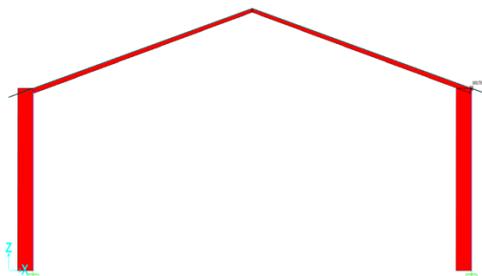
Perbandingan nilai axial struktur bangunan baja tanpa bracing dan dengan bracing
